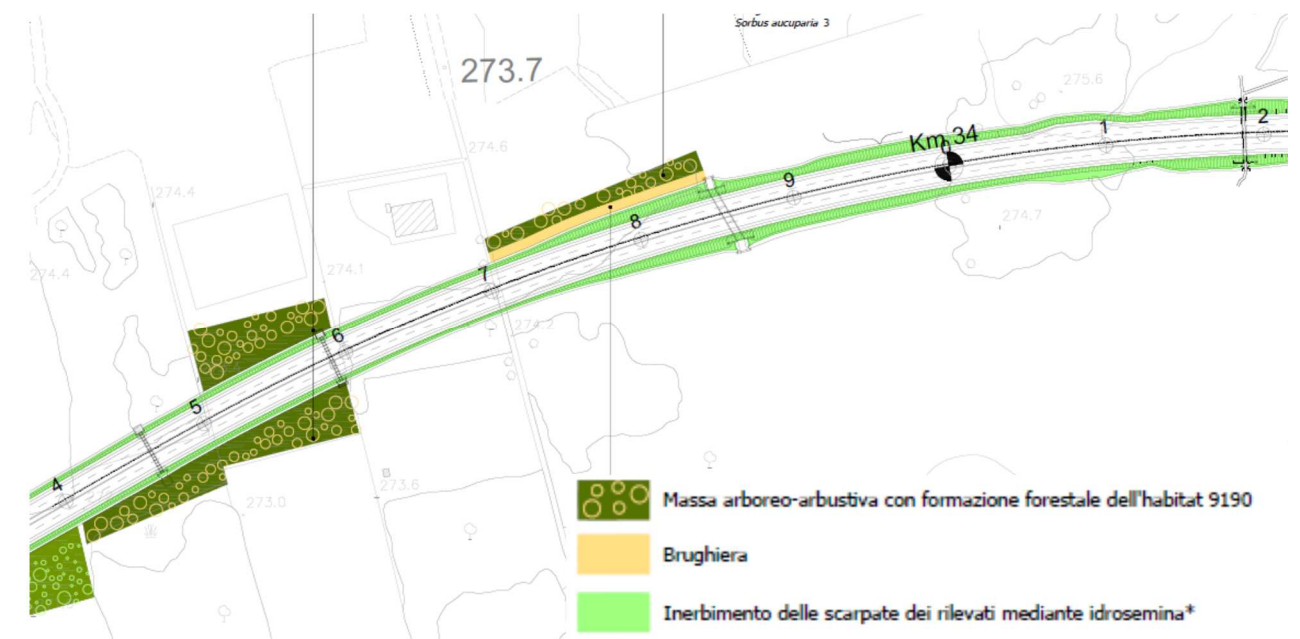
Stralcio Planimetrico della Planimetria di dettaglio interventi opere a verde.
